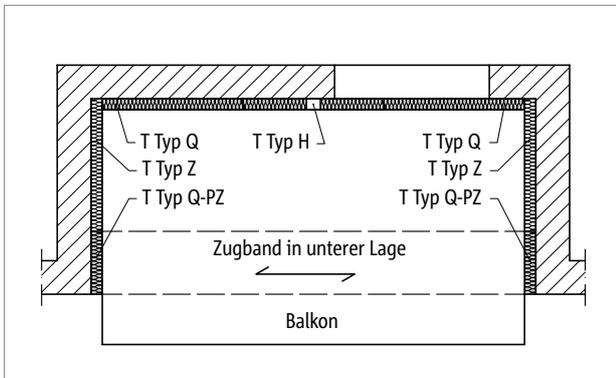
Schöck Isokorb® T Typ Q, Q-PZ: Dreiseitig gelagerte Loggia - symmetrisch mit Zugband
